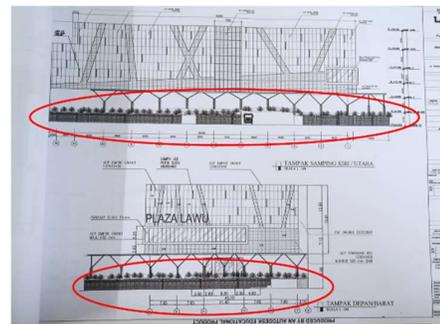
Fasad *Green Wall* di Entrance Parkir
